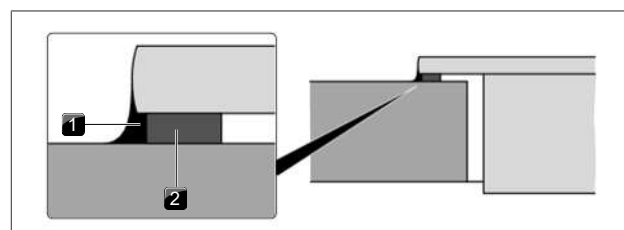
Ruban d'étanchéité pour montage en saillie
